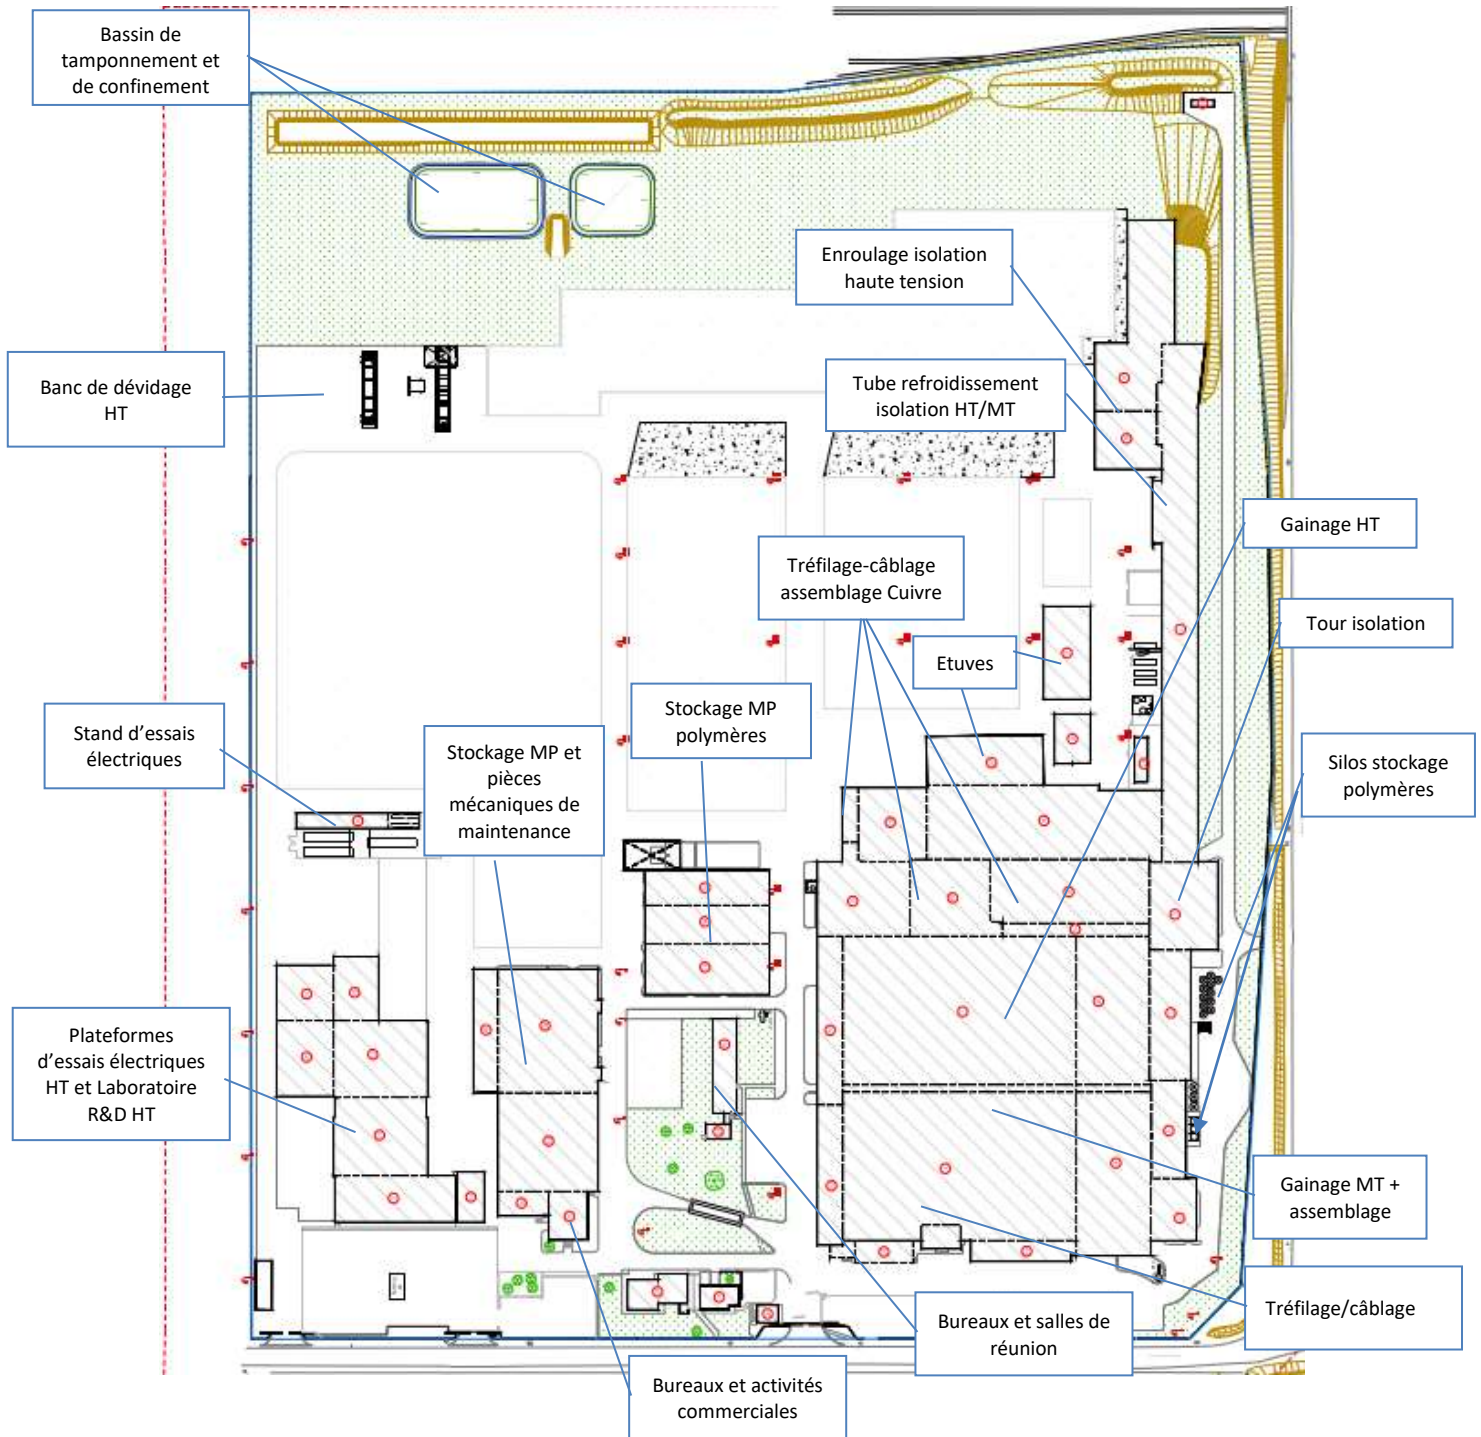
Plan de masse existant (source : PRYSMIAN)
